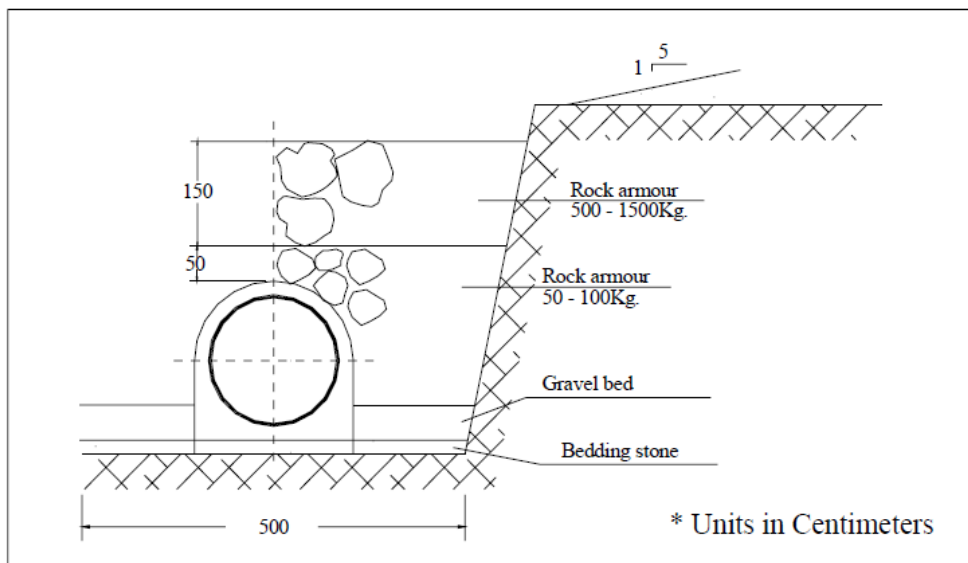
Perfil transversal de uma solução de proteção estrutural. Trincheira escavada sobre fundo rochoso com enchimento de enrocamento. *Alvarez et al., 2002
